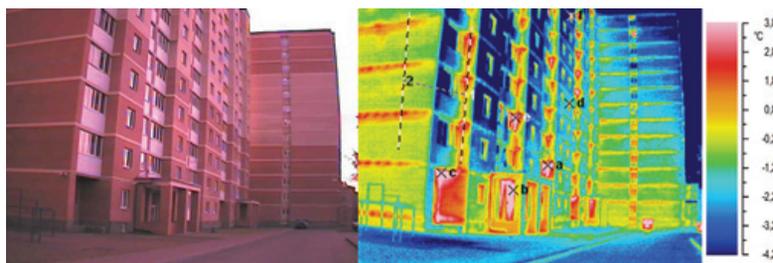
Фасад дома со слоистыми стенами и облицовкой из кирпича и его термограмма
